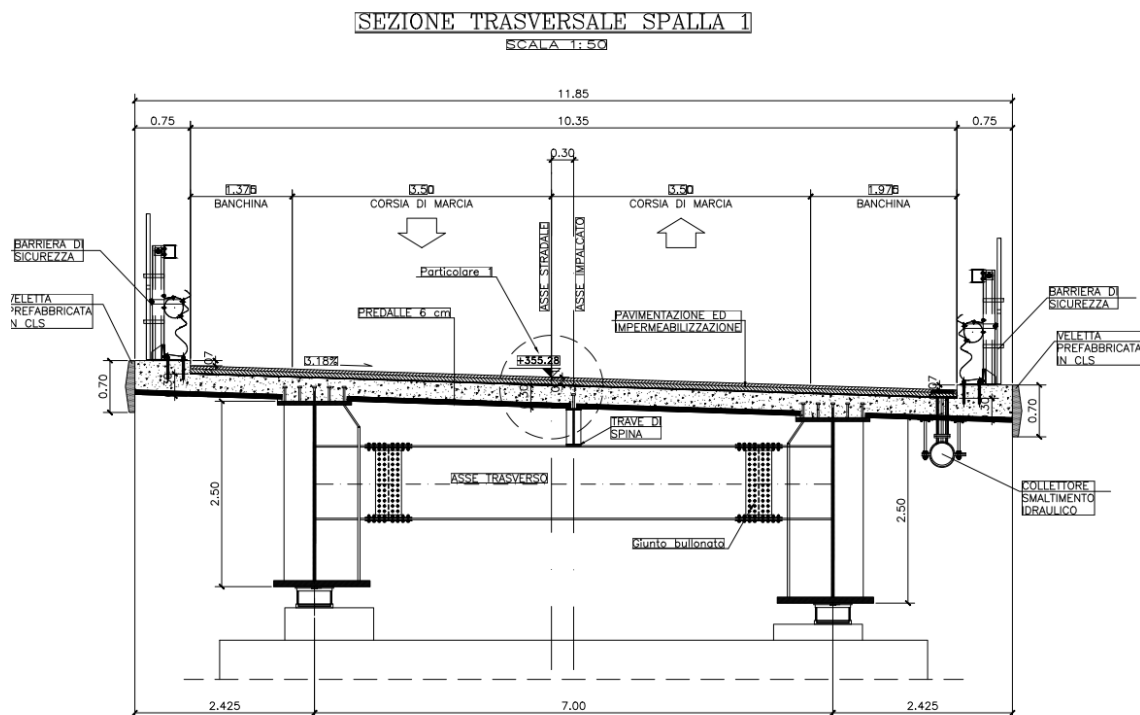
Sezione trasversale dell'impalcato - sezione su spalla S1 (sezione tipo1)
